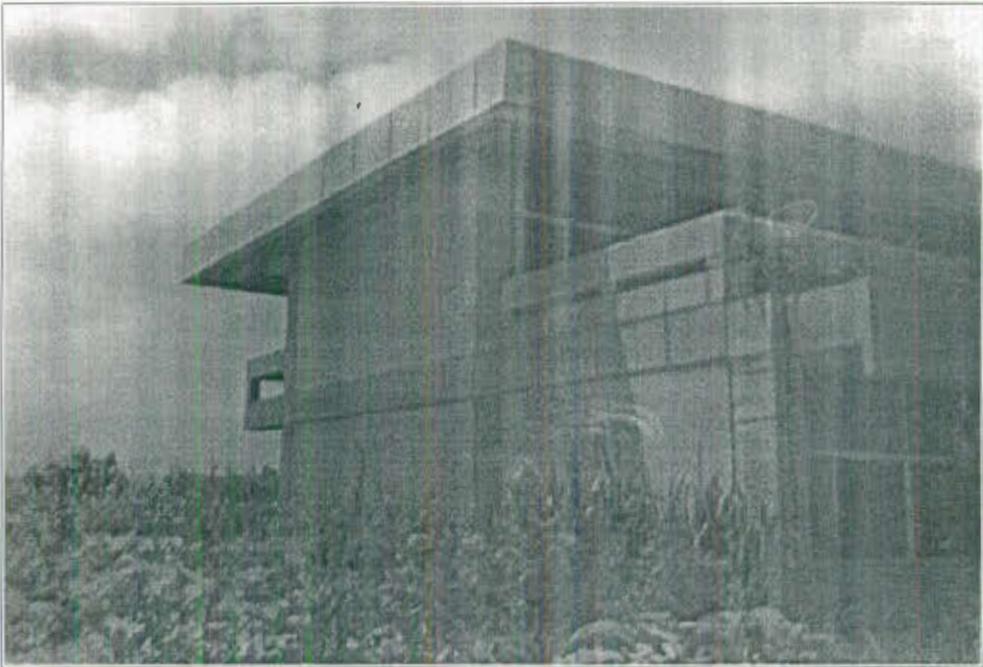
VISTA LATERAL IZQUIERDA DE EDIFICIO DE AULAS DE F.I.M.C.M.
